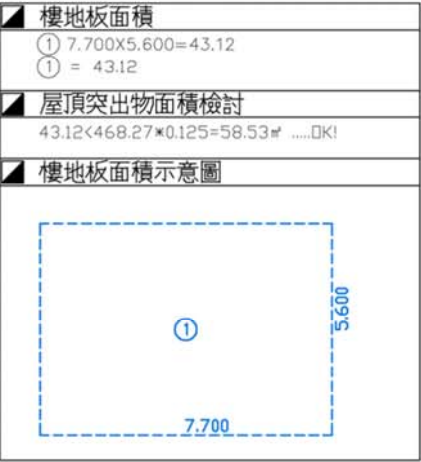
屋突一層平面及面積計算圖(S=1/200)
